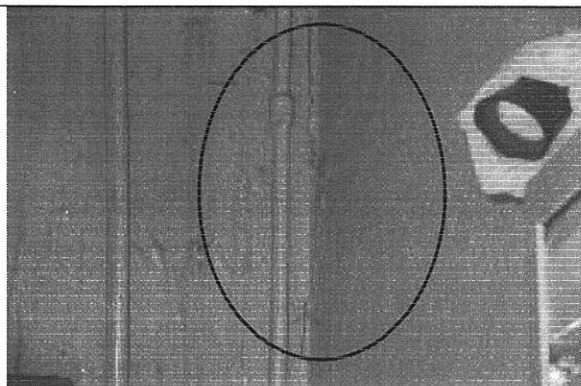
Agrietamiento en muros del costado sur en el tercer nivel
